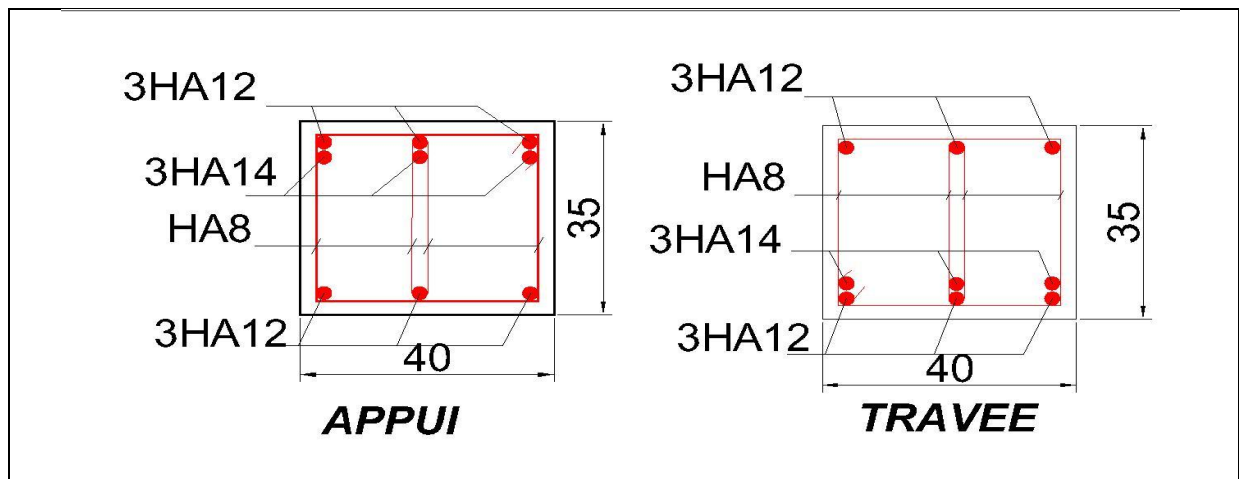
schémas de ferrailage des poutres secondaires pour tous les niveaux
